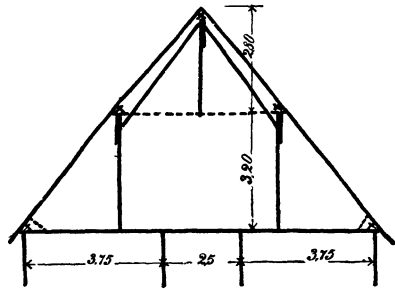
Pfettendach mit dreifach stehendem Stuhl.
